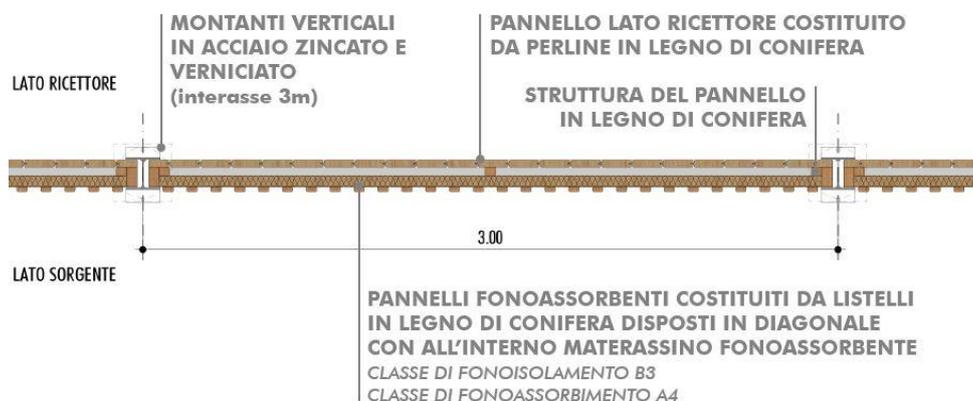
SEZIONE ORIZZONTALE – PANNELLO OPACO
